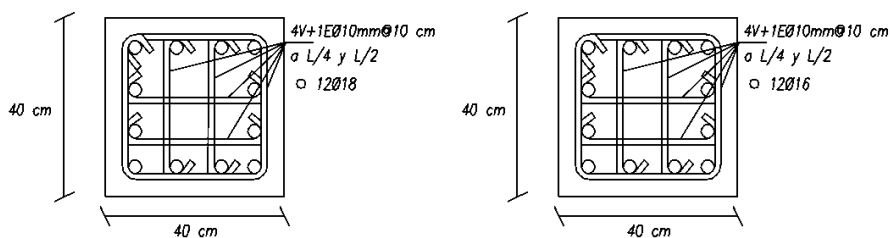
Armado obtenido de columnas, estribos confinamiento.
